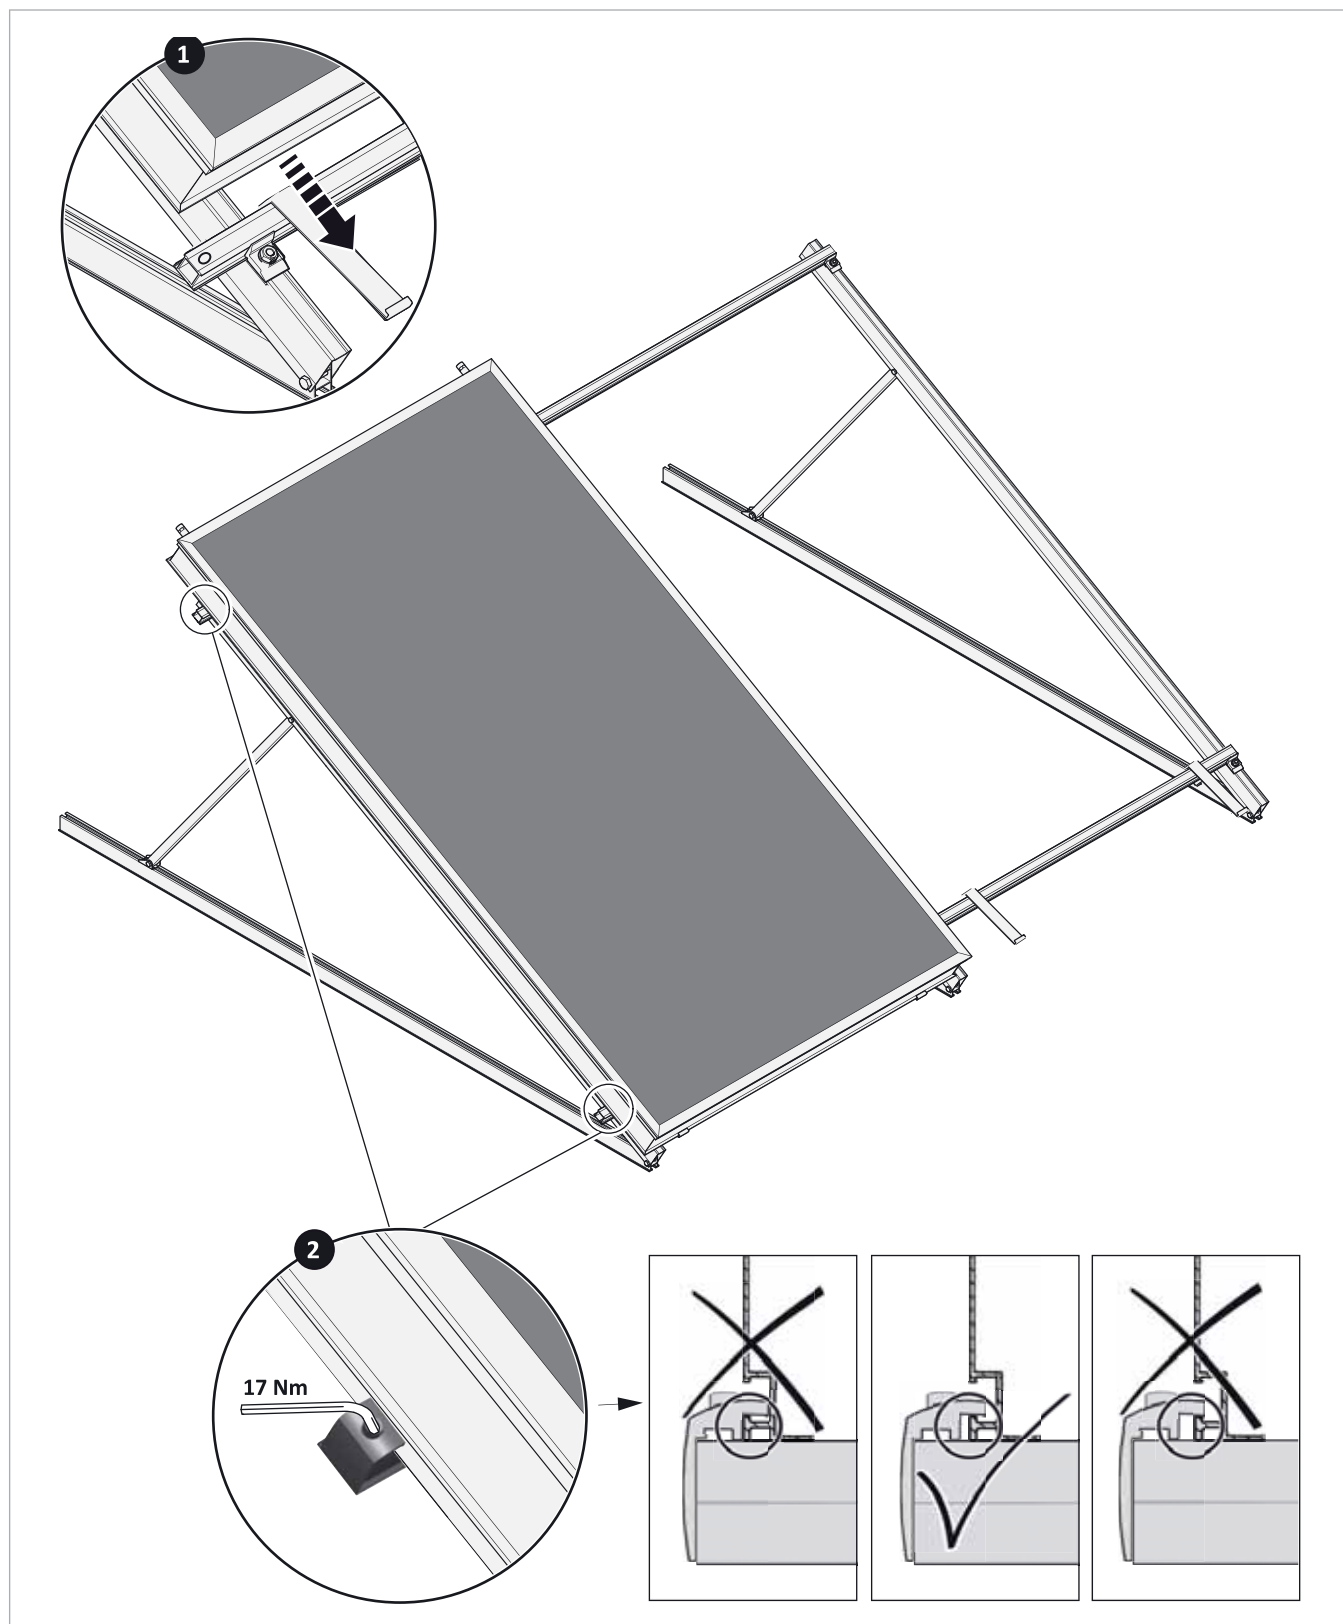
fissaggio di un collettore ai supporti per tetto piano
